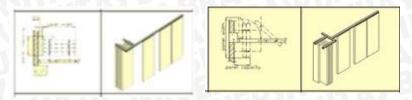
Fleksibilitas Lantai pada ruang Plennary Hall
